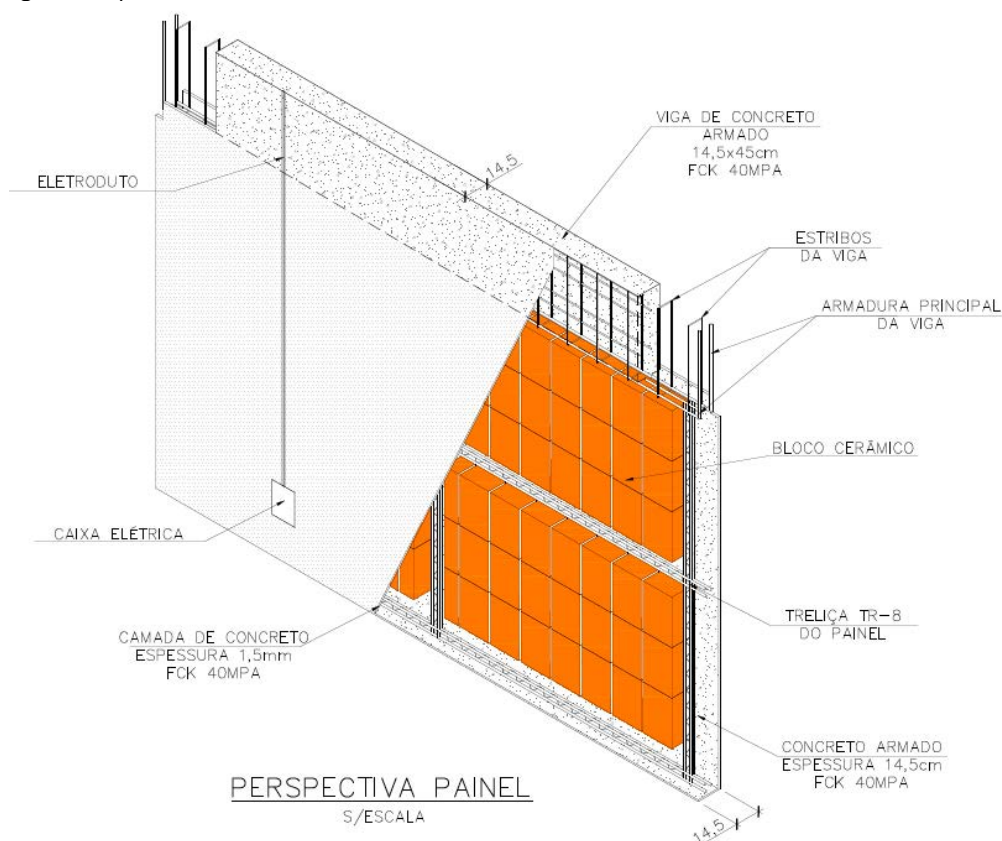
Desenho esquemático do painel de vedação pré-fabricado com viga incorporada.
